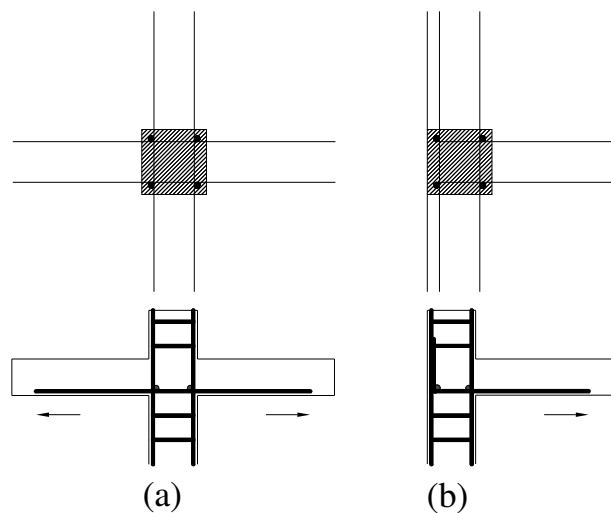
Armadura inferior laje-pilar: (a) pilar interno; (b) pilar de borda (CEB-FIP/1993)
